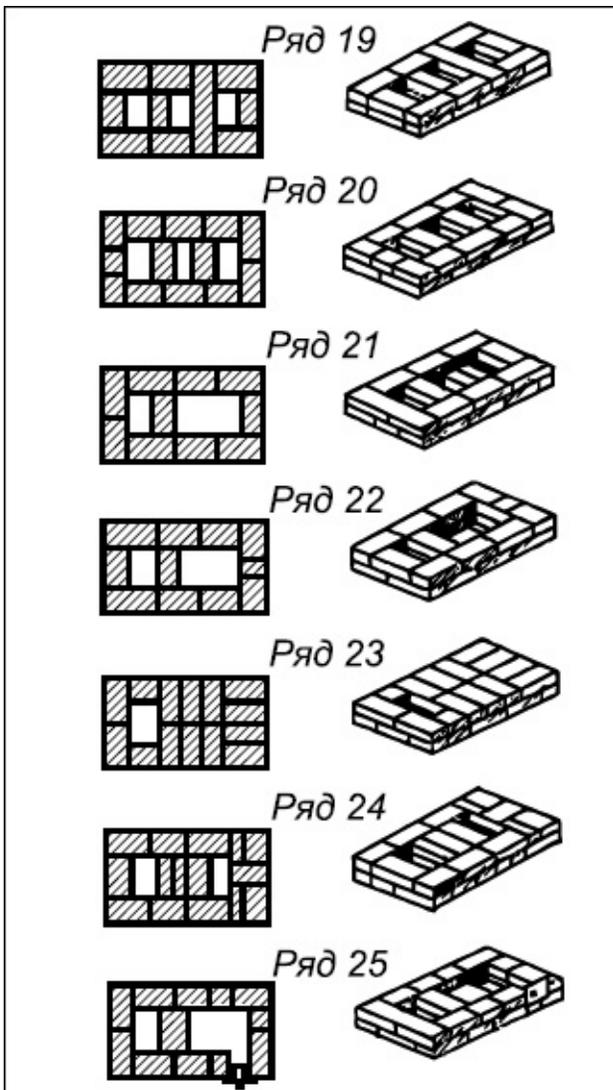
(продолжение). Кладка отопительной прямоугольной печи
